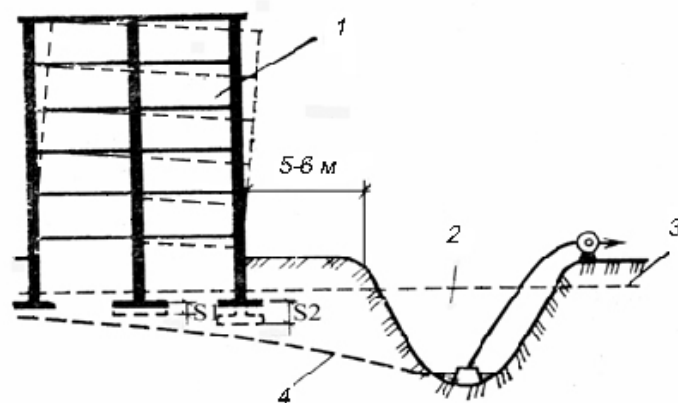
Деформация жилого дома, вызванная открытым водоотливом из смежной с ним траншеи: 1 – жилой дом; 2 – траншея; 3 – уровень подземных вод до откачки; 4 – то же, после откачки
